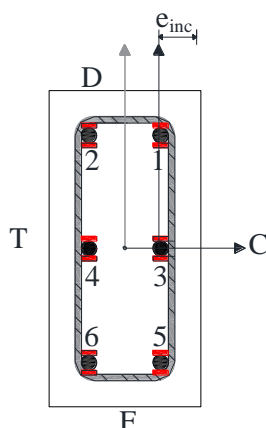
Posição dos extensômetros nas armaduras longitudinais
